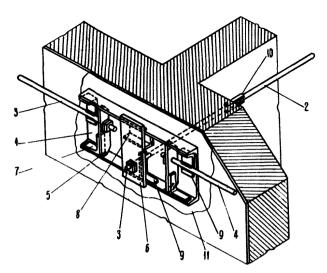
Схема промежуточного обжимного элемента с одиночными тяжами:
